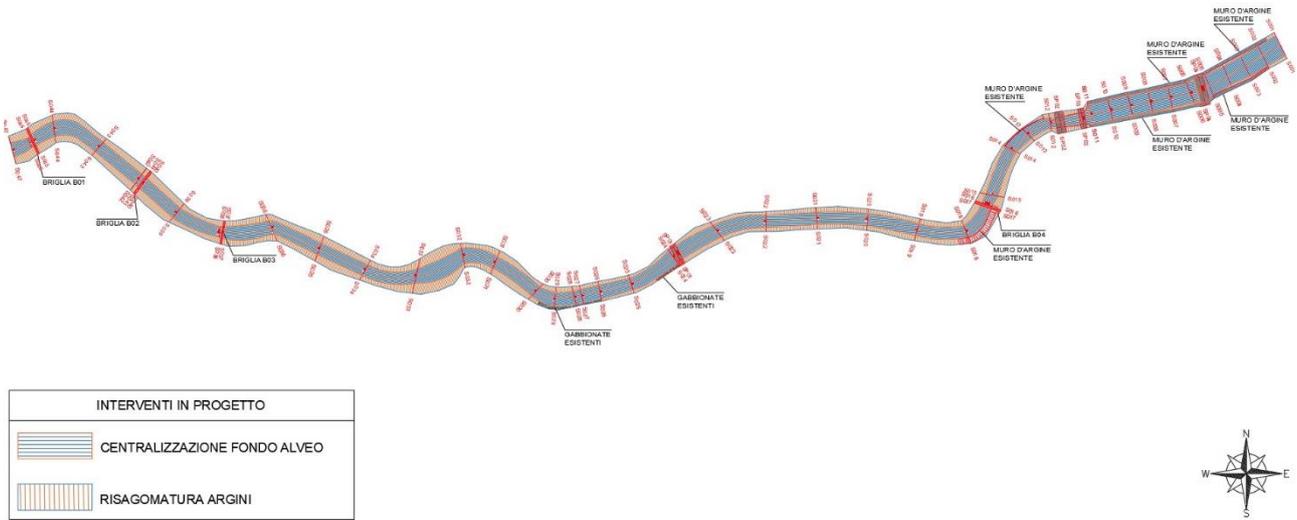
Torrente Borrone – Planimetria con interventi di progetto
